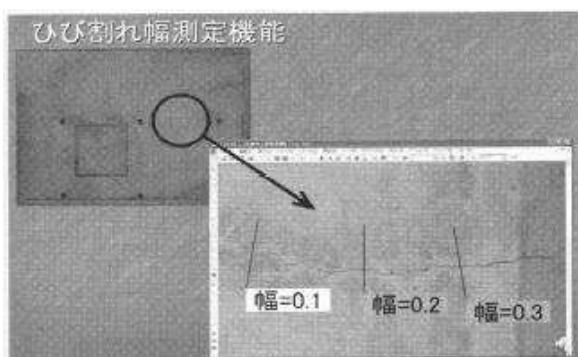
ひび割れ幅の測定 (⑤-1)
